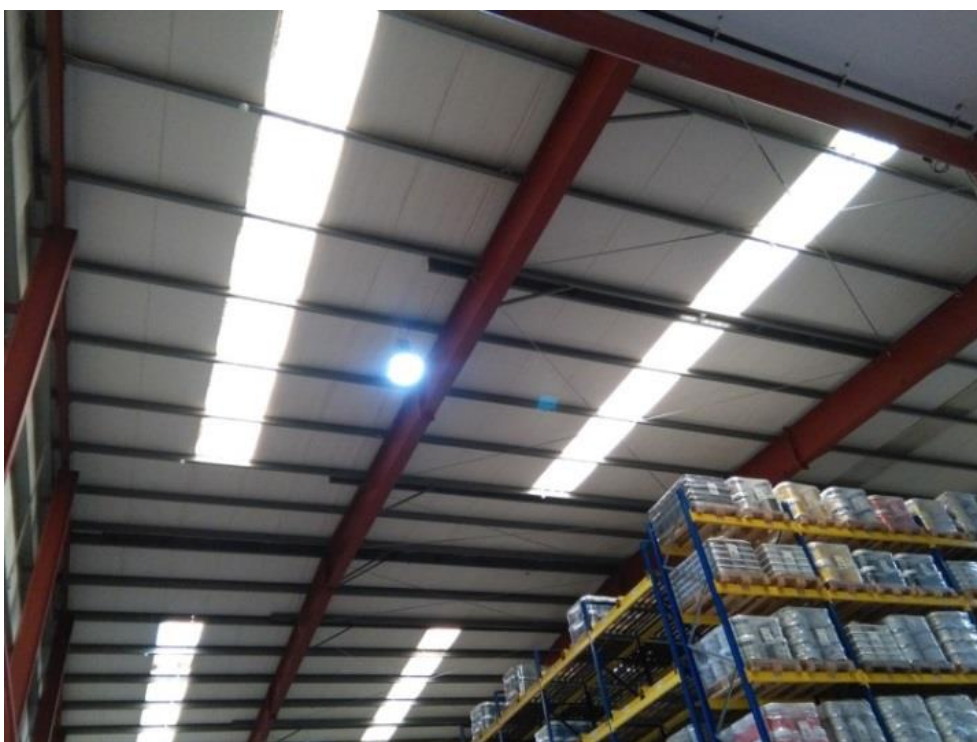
Vista interior do telhado com estrutura de reforço
